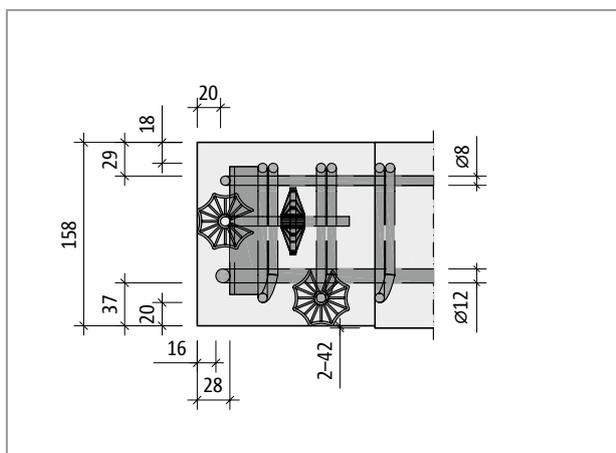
Schöck Tronsole® Typ Z: Seitenansicht einer Auflagerkonsole mit eingebautem Tragelement
